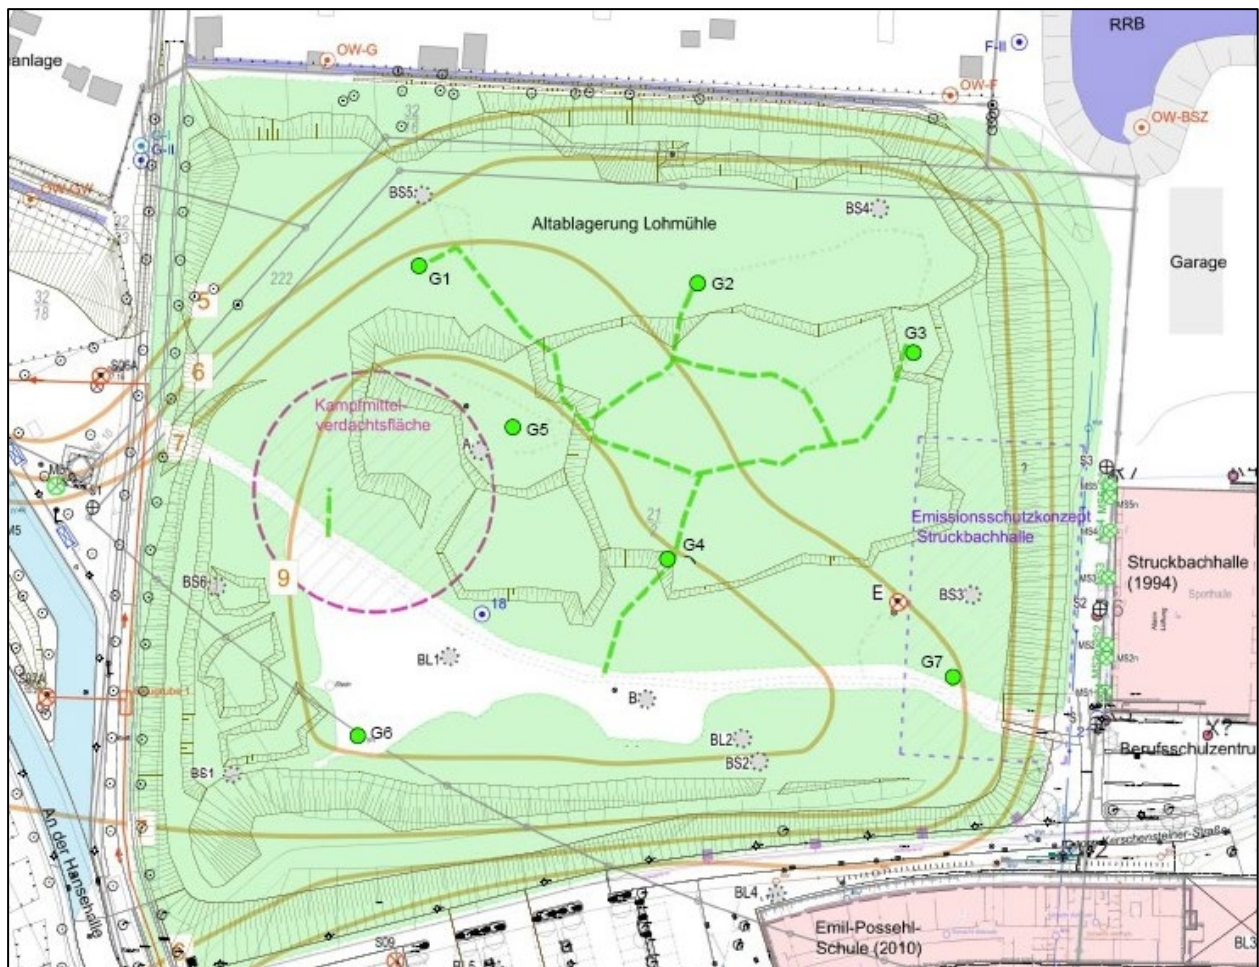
Lageplan der Bohrungen (vollständiger Plan in Anlage 4)
